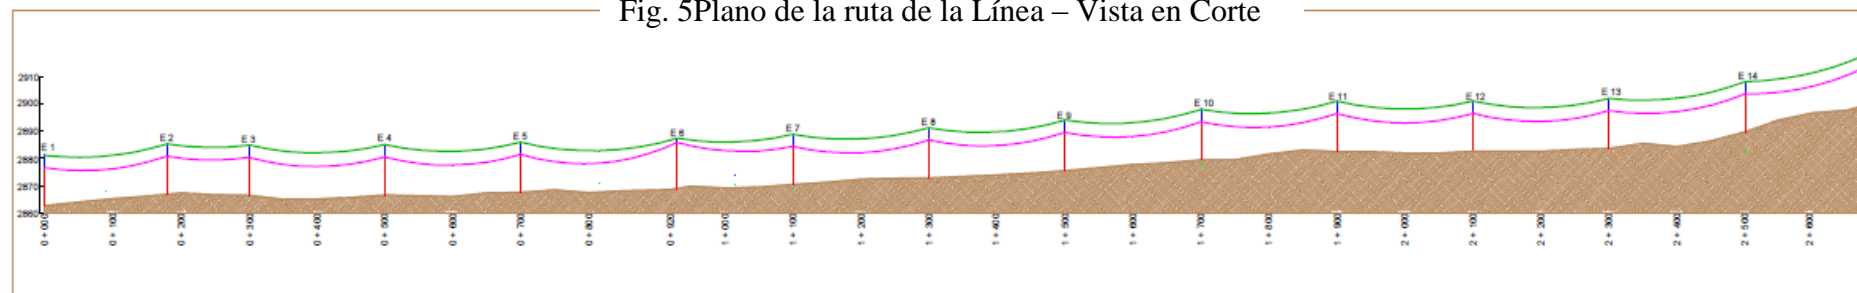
Plano de la ruta de la Línea – Vista en Corte
